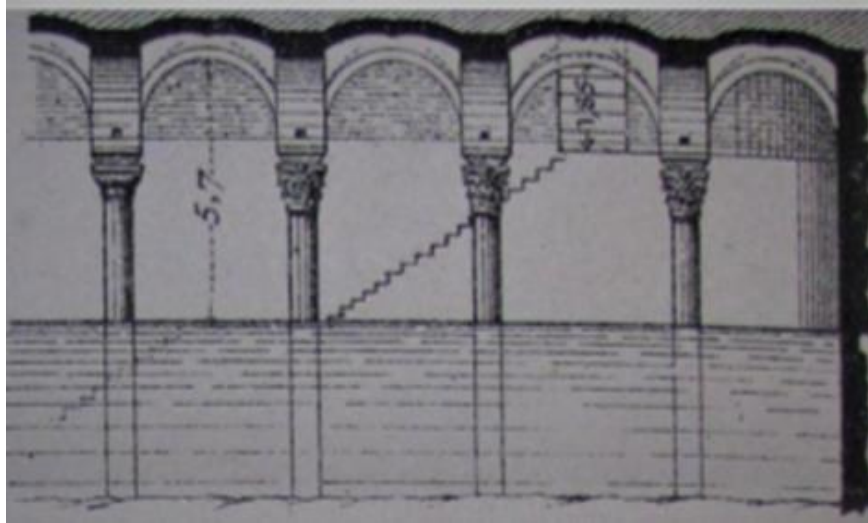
Yerebatan Sarayı Sarnıcı planı
